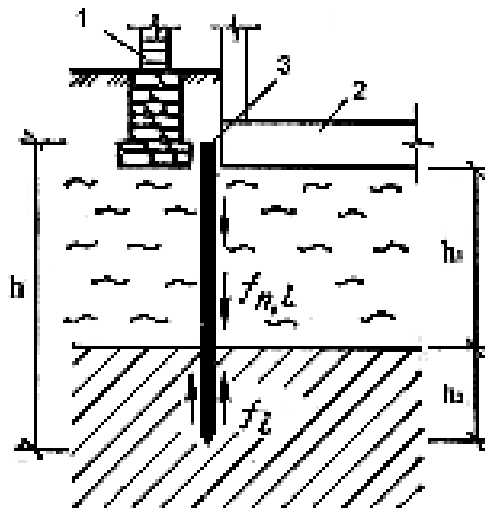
Роз'єднувальна шпунтова стінка: 1 – фундамент існуючої будівлі; 2 – фундамент споруджуваної будівлі; 3 – роз'єднувальний шпунт
